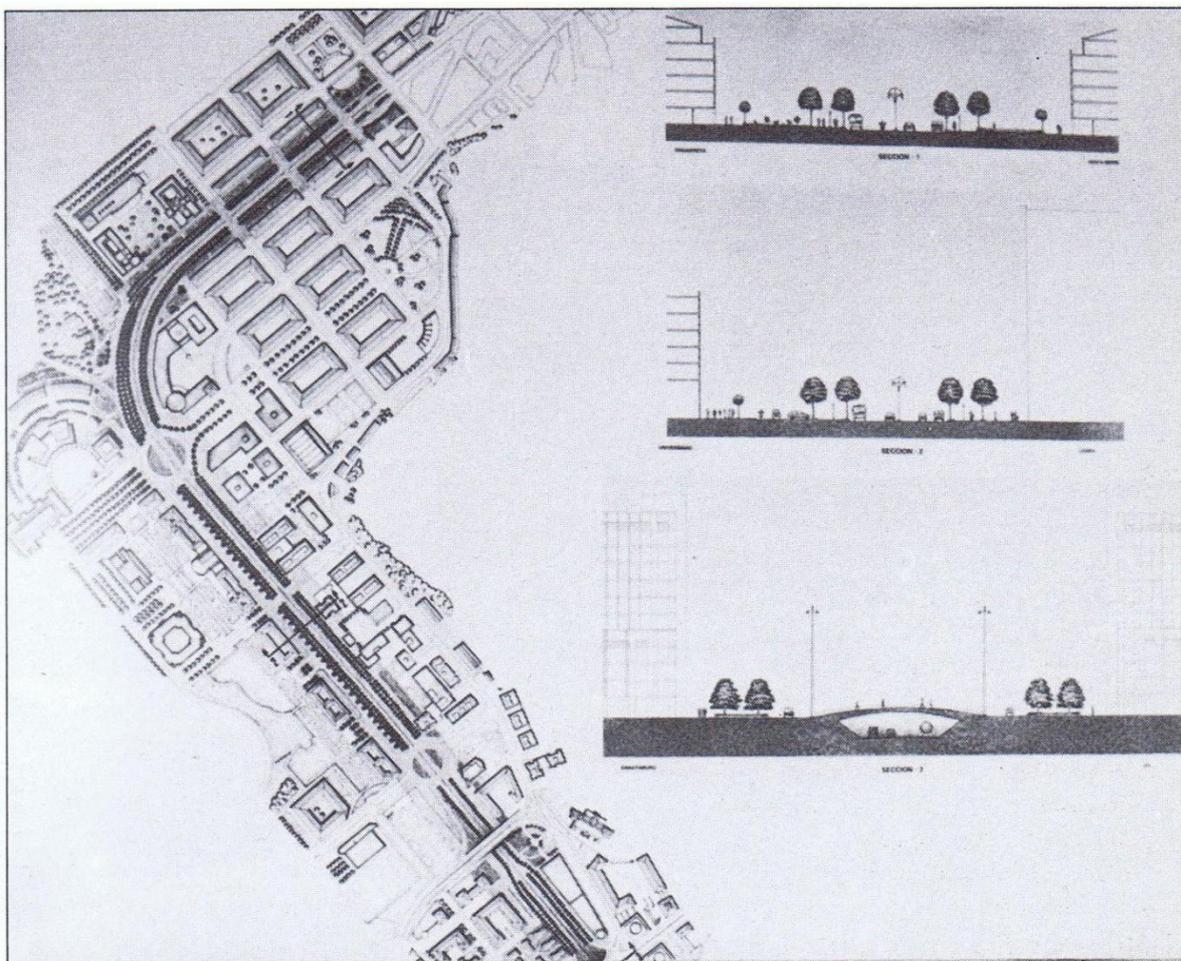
Plano de la primera propuesta de la Oficina del Plan General - Revista Ayunt. San Sebastián nº 9. Pág. 7
